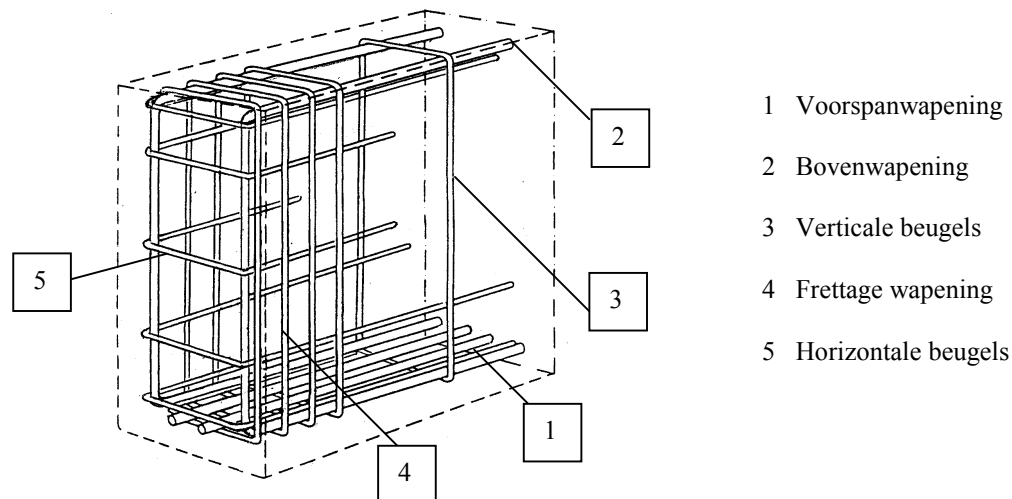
Schikking wapening in eindblok van voorgespannen balk
